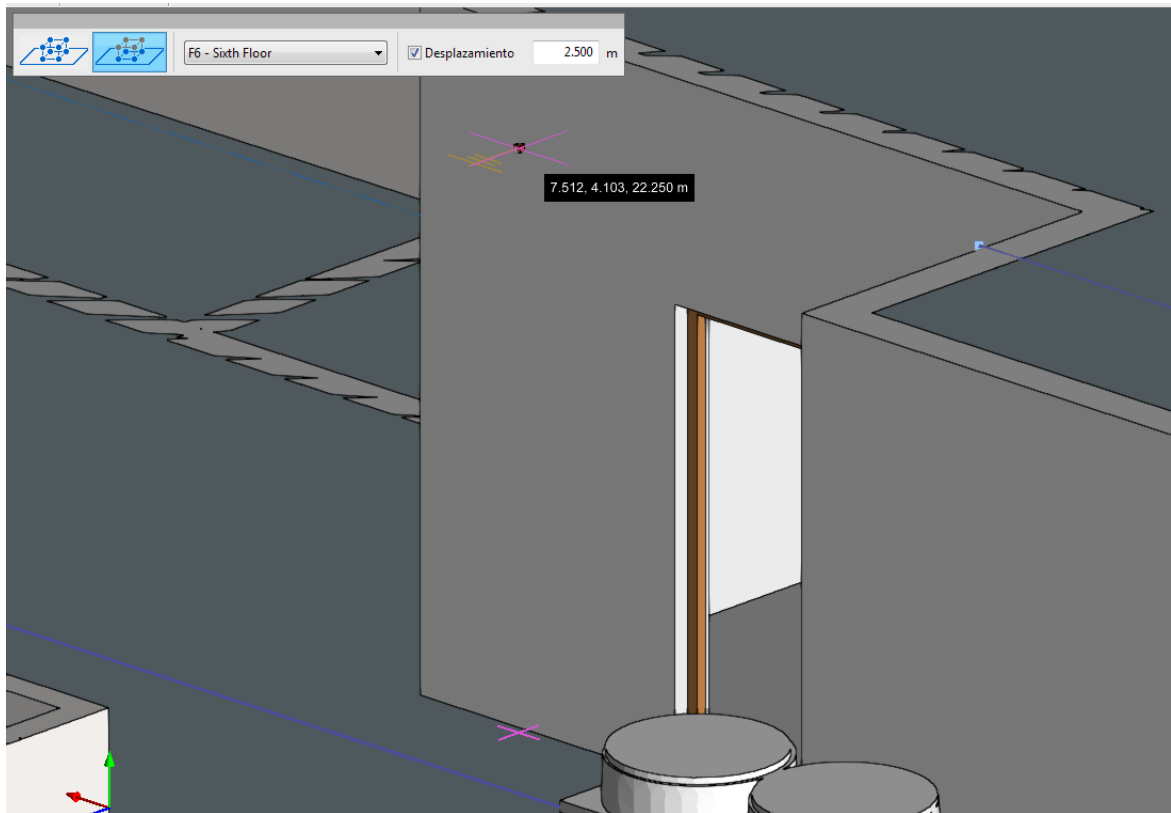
Inserimento di un elemento con spostamento nel piano di lavoro (Open BIM Lightning)
